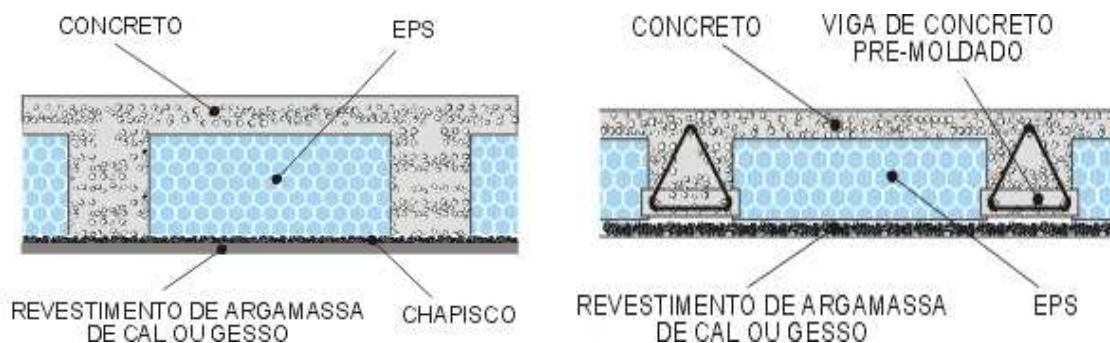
Elemento de enchimento em laje nervurada e industrializada.
